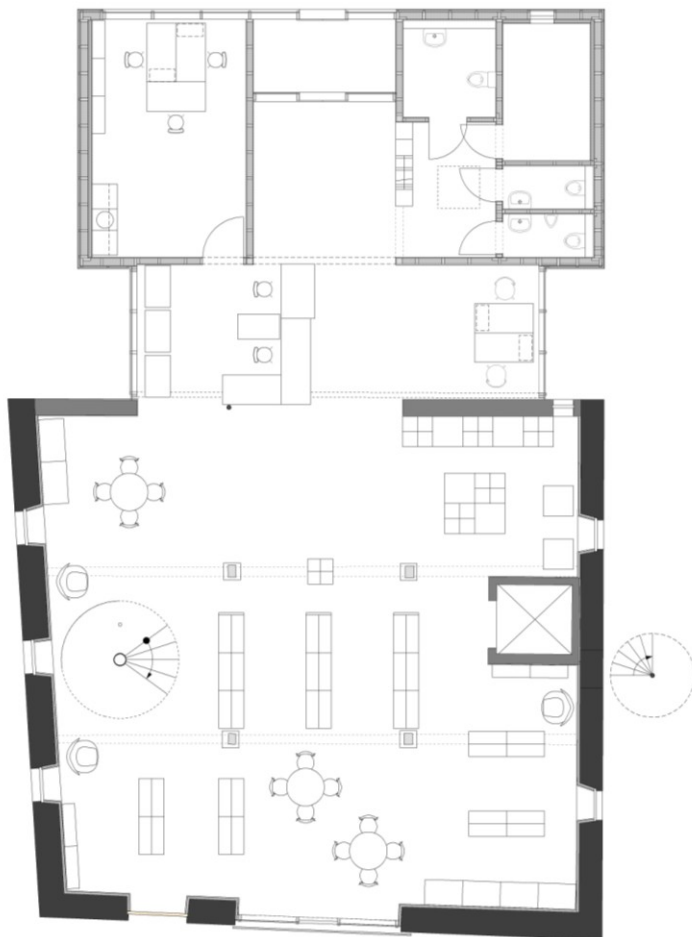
Grundriss EG. © M. Wypior.
